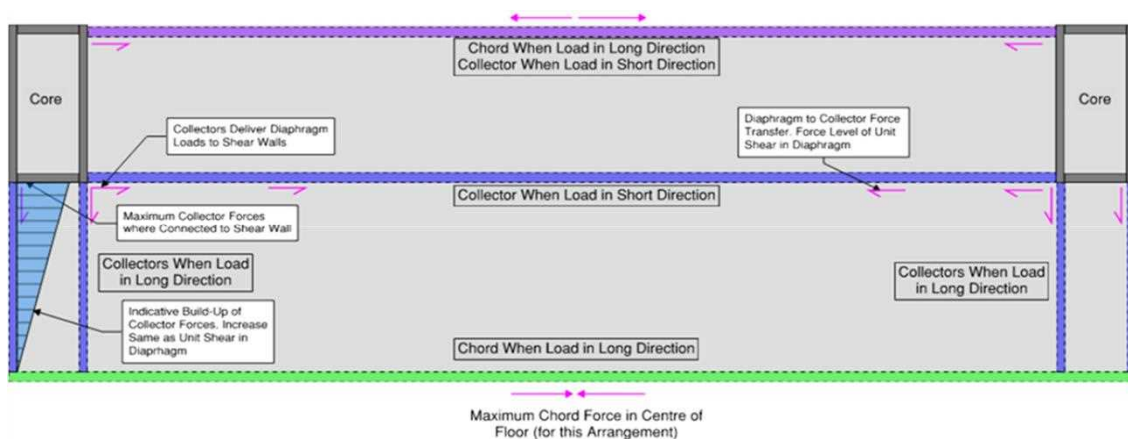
Planta estrutural de um piso exemplificativa de um diafragma simples.
